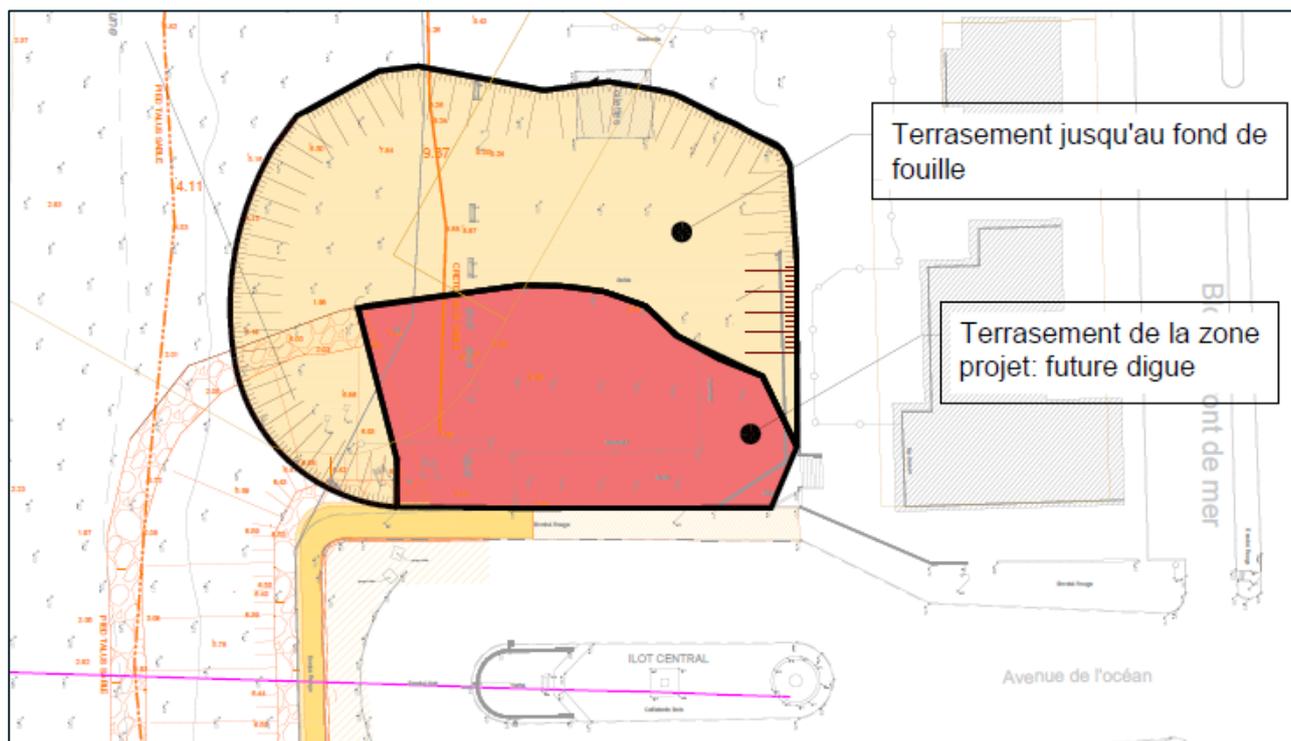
EXTRAIT DU PLAN DE TERRASSEMENT – TALUS NORD
